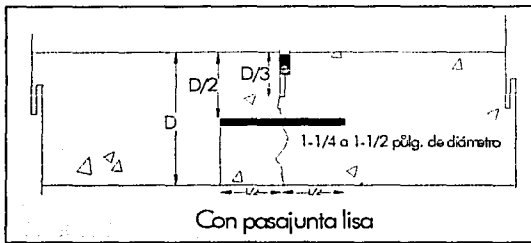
Junta transversal de contracción con pasajunta lisa.
